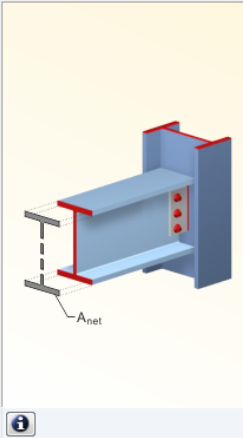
Querschnittsfläche für Zugnachweis definieren
